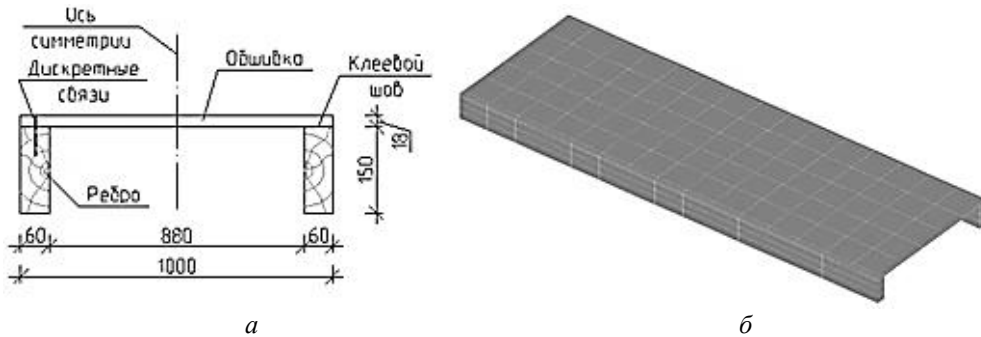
К выбору расчетной схемы панели: *a* – схема поперечного сечения панели перекрытия; *б* – расчетная модель панели перекрытия, составленная из прямоугольных конечных элементов
